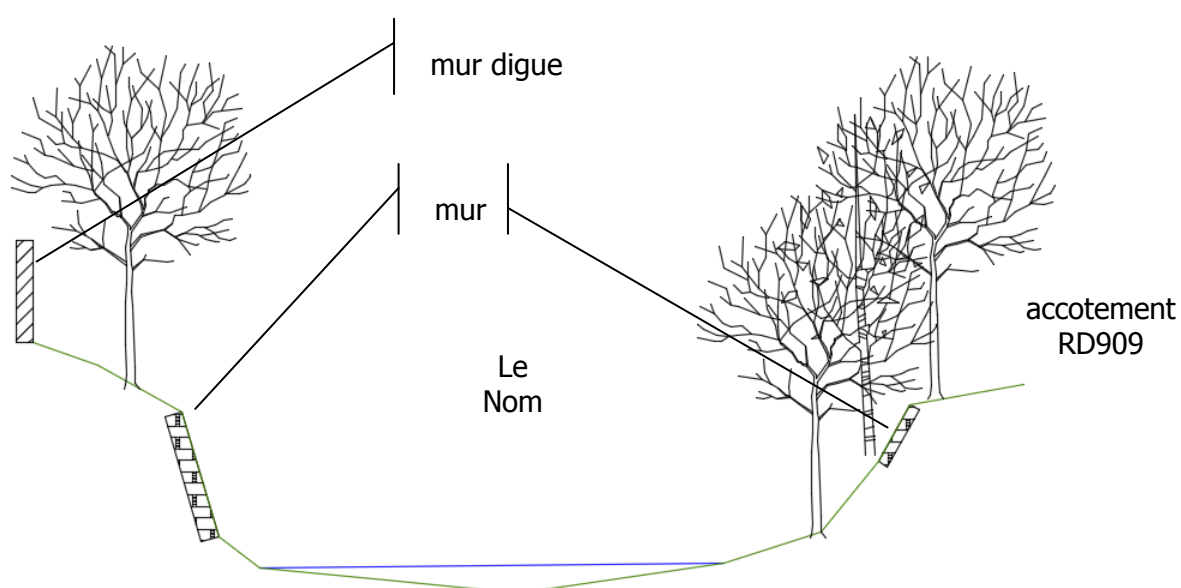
Section type du lit mineur du Nom au droit du site d'étude
